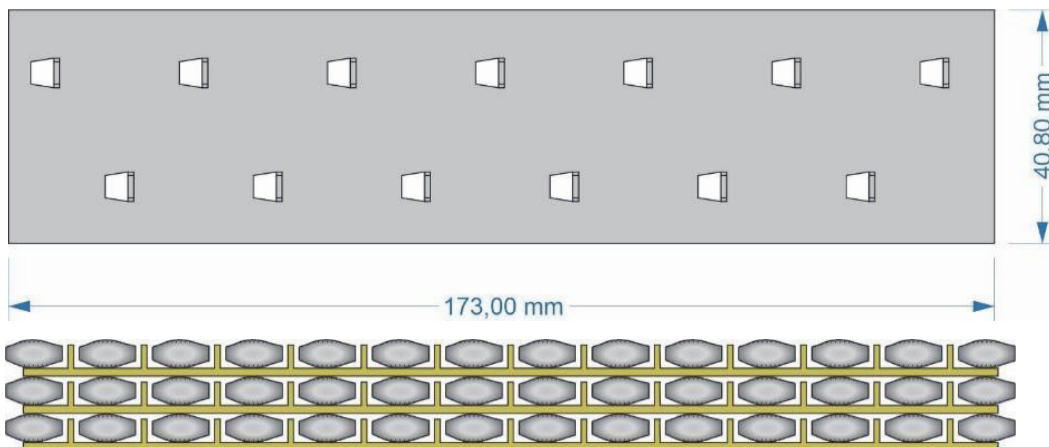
oben: schematische Darstellung eines Abstandshalterbleches als Stanzteil mit einer Materialdicke von 1 mm, gemäß [TGL 173-33: 1967] zur Lagesicherung von 14 nebeneinanderliegenden Spannstählen und unten ein Schnitt durch drei Spannstahllagen mit Abstandshalterblechen
